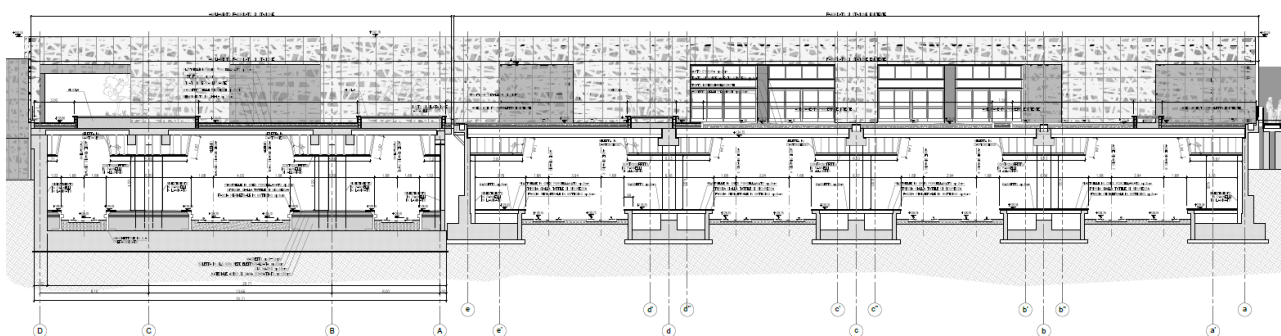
Sezione trasversale in corrispondenza del piazzale lato Milano – prospetto sud.
